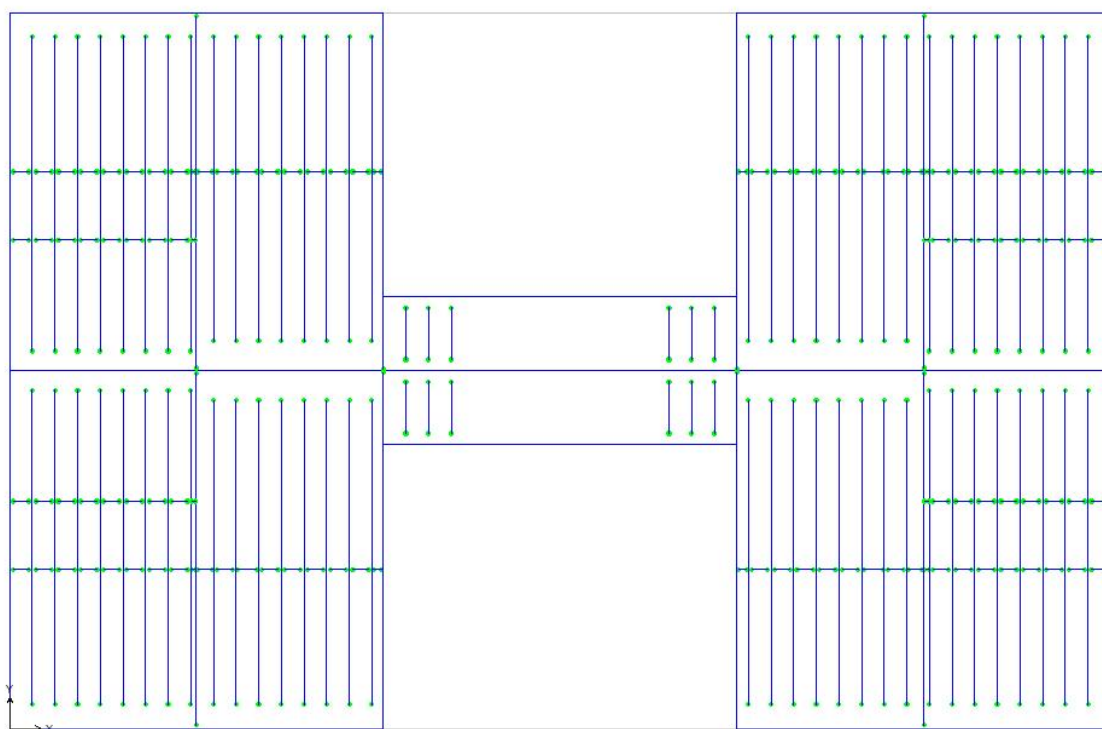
(b) – Esquema estrutural para vigamento contínuo
